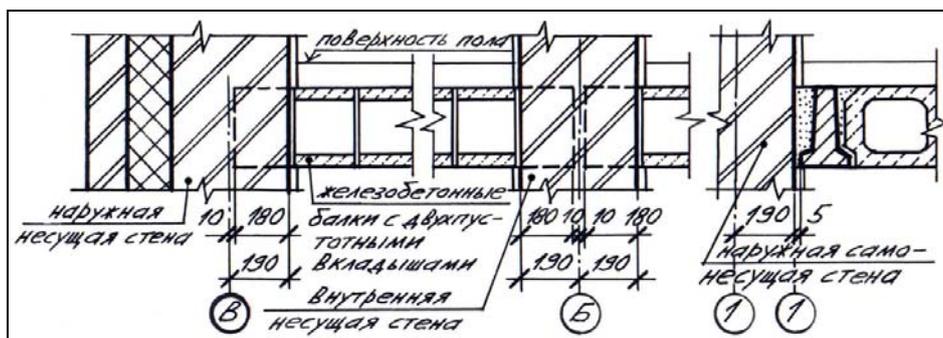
Привязки в случае междуэтажного перекрытия из сборных железобетонных балок и двухпустотных легковесных вкладышей
